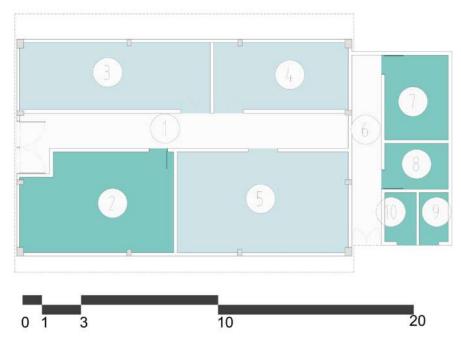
Planta 1 Bloque 52. Fuente: Equipo de diagnóstico.
